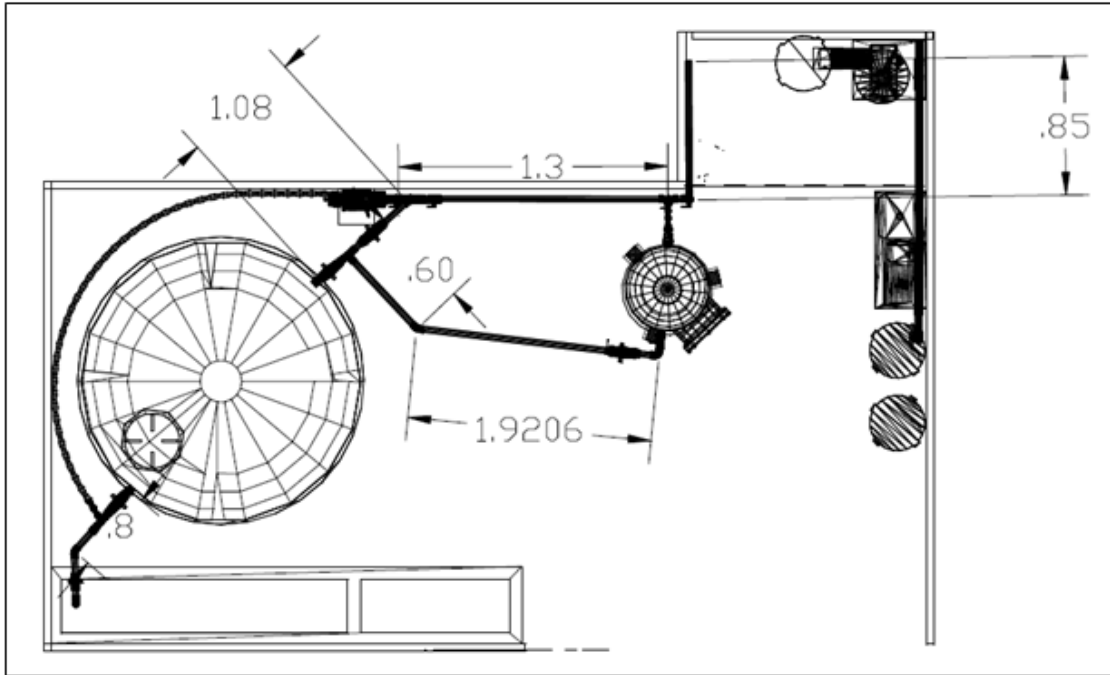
Plano con acotaciones vista superior referente a tuberías de la planta de biogás (Juárez-Hernández, 2011)
